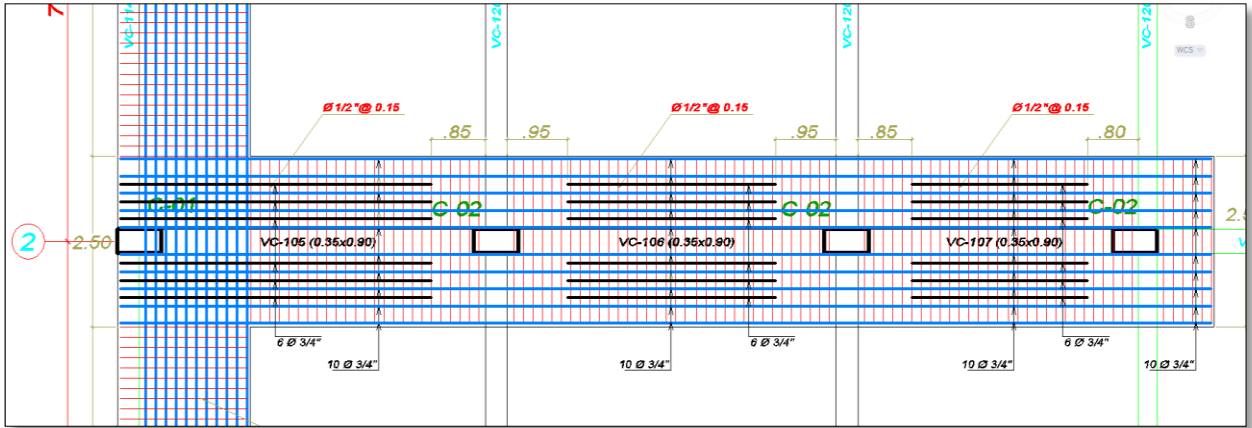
Detalle del Refuerzo de la viga T invertida.
